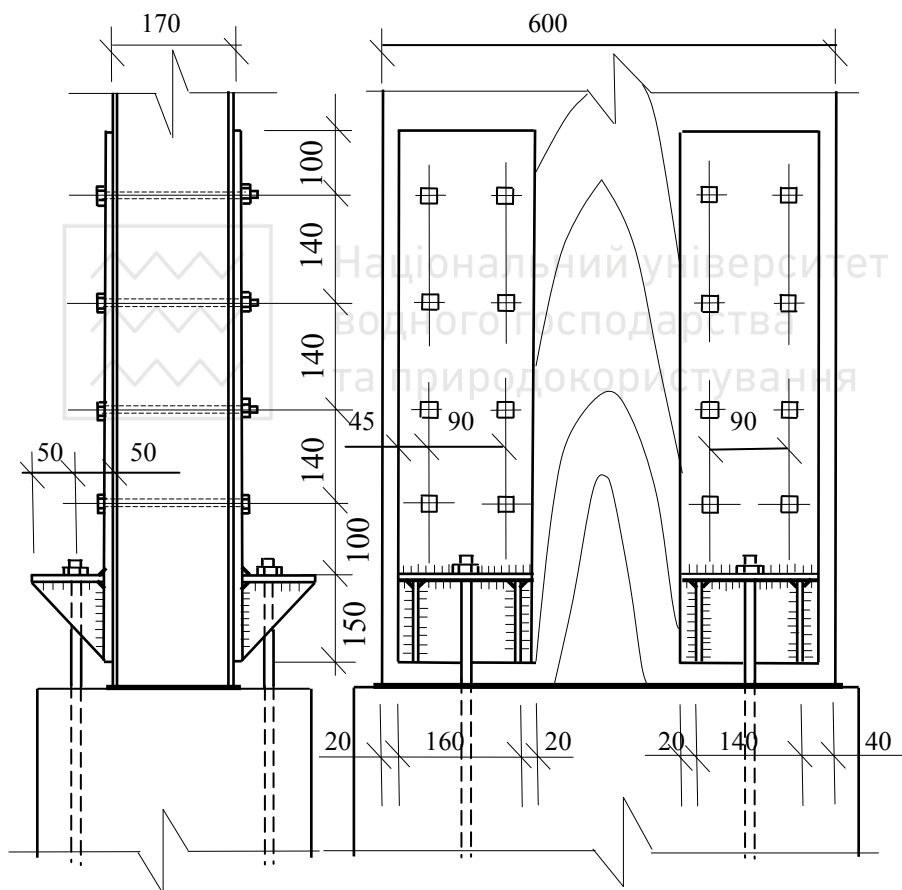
Опорний вузол кріплення колони до фундаменту
